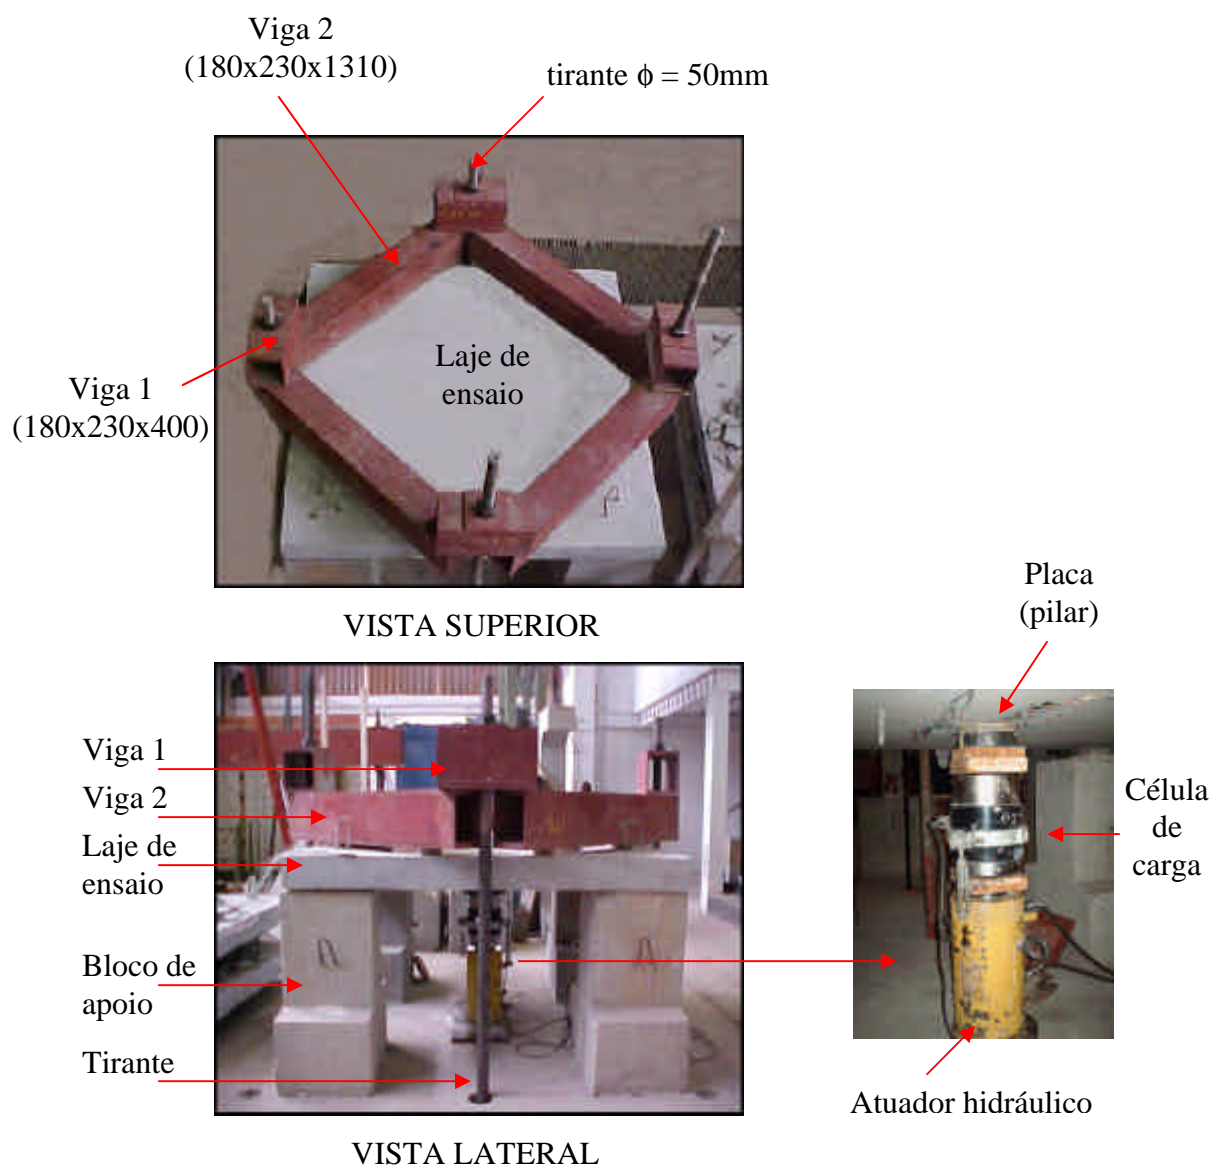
Laje montada para a realização do ensaio – Vista superior e vista lateral
